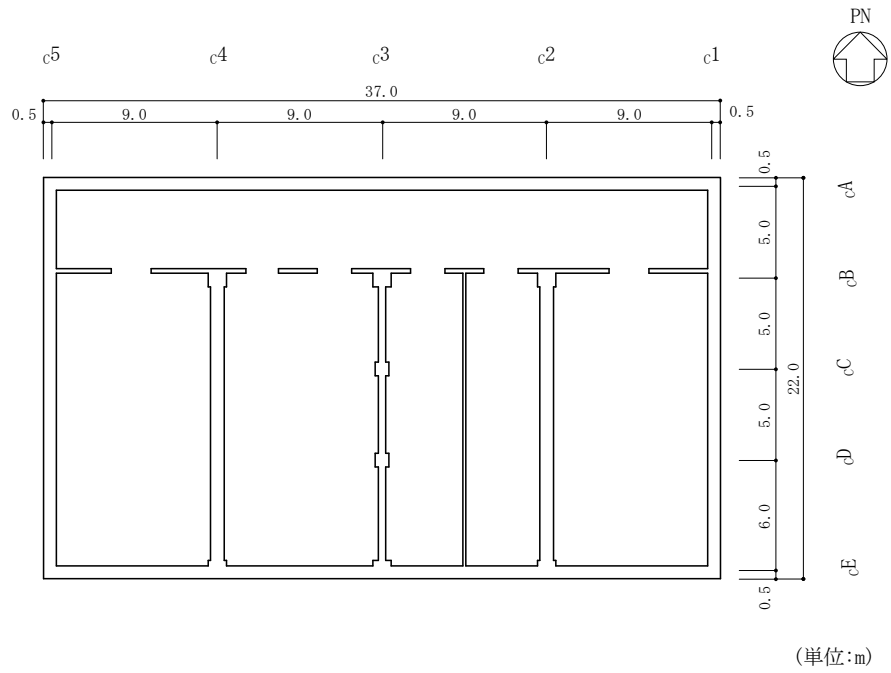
制御室建物の概略平面図 (EL 1.6m*)
